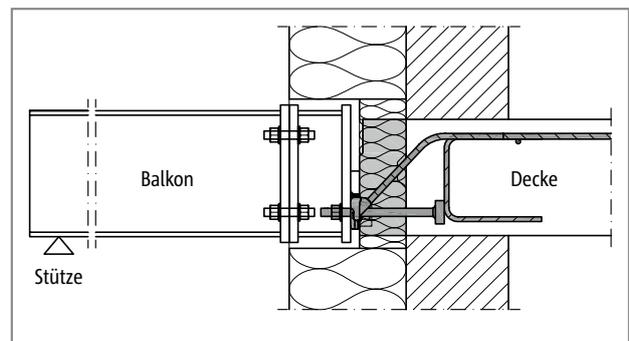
Schöck Isokorb® T Typ SQ: Anschluss des Stahlträgers an einen Adapter, der die Dicke der Außendämmung ausgleicht
